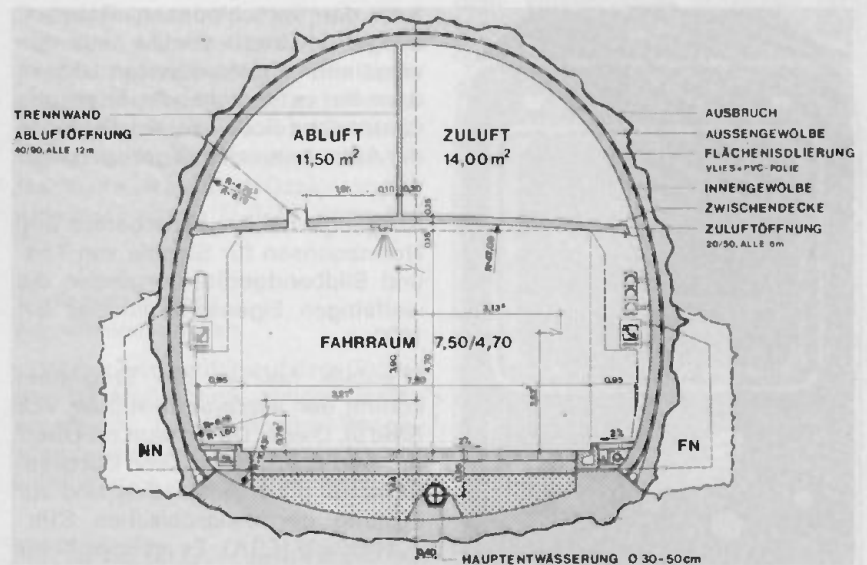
Querschnitt durch eine Tunnelröhre des Arlbergtunnels
